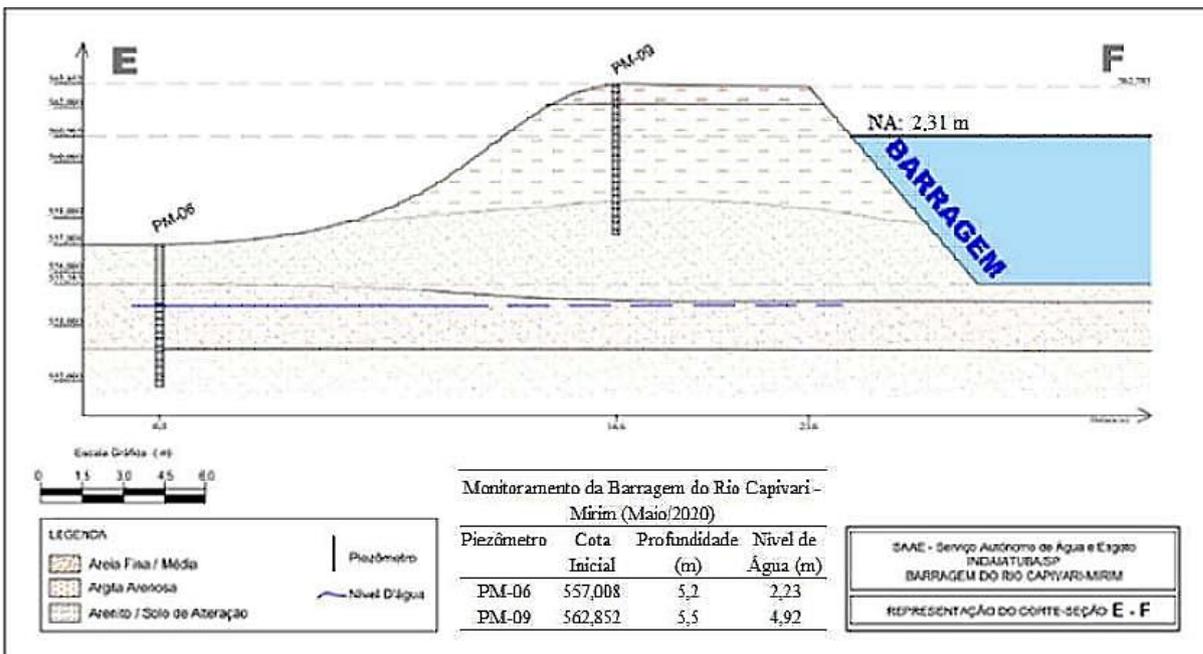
Esquema de instalação dos piezômetros da Seção E-F
